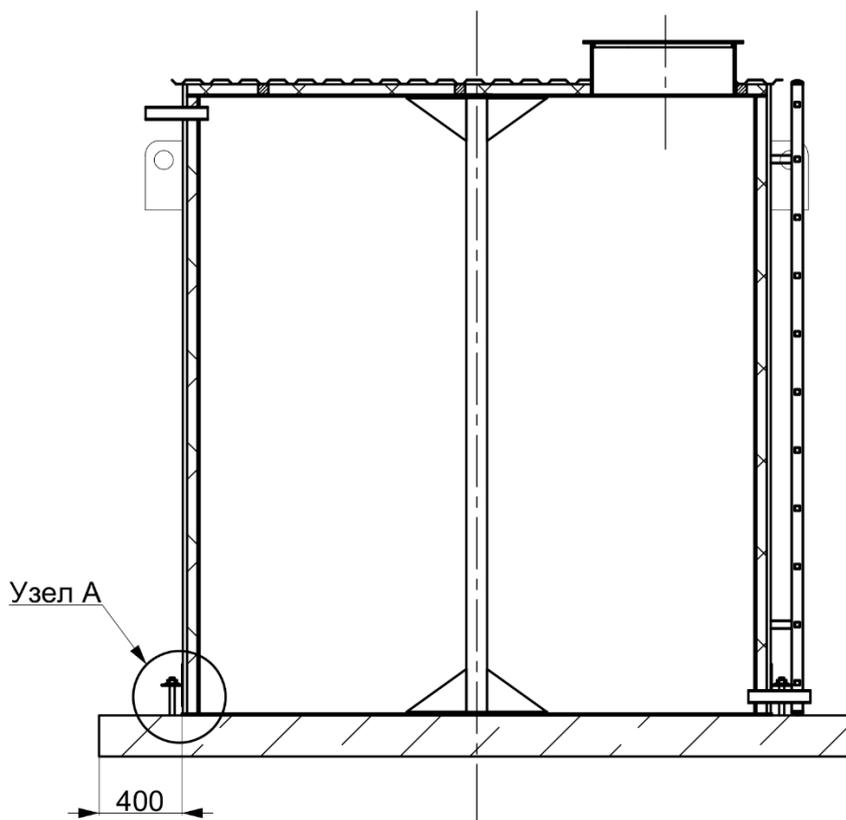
Монтаж утепленного РВП с креплением к ж/б плите
